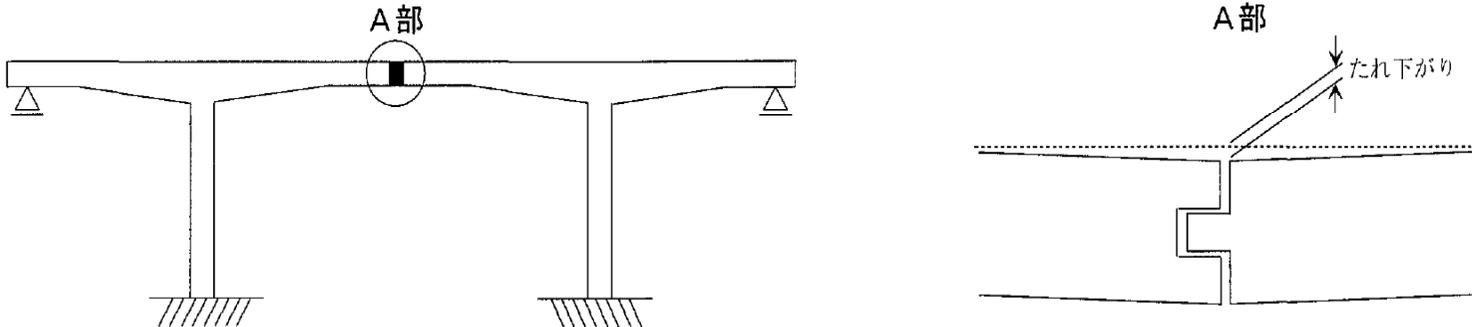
ゲルバーヒンジ部付近のひび割れ
